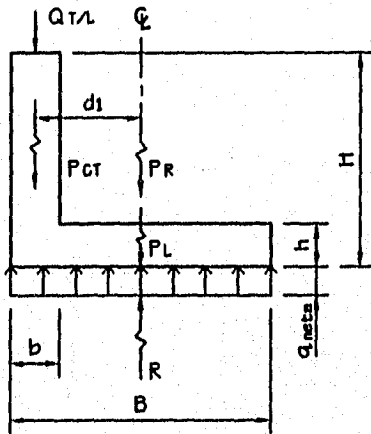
ZAPATA DE COLINDANCIA CON TRABES DE LIGA
